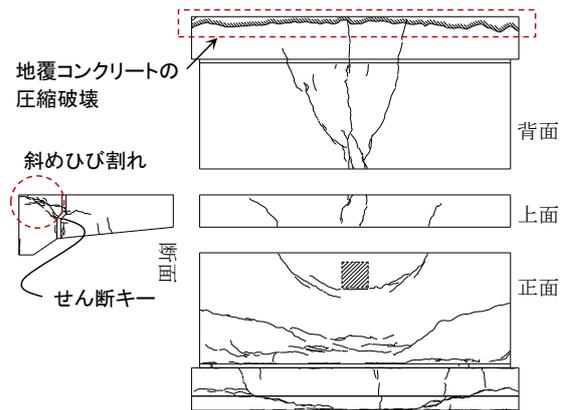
終局時のひび割れ展開図 (CASE-1)
